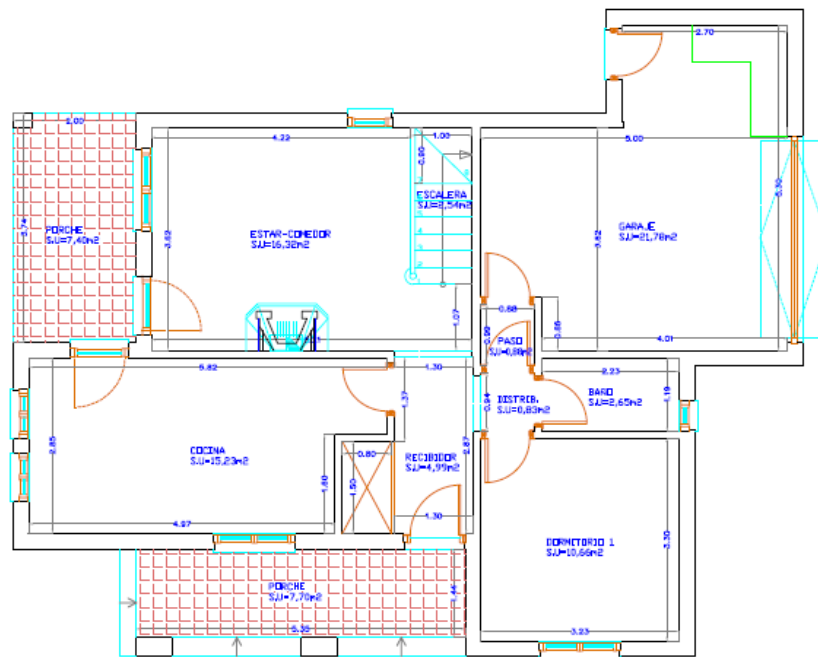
Plano planta baja de la vivienda (Fuente: Elaboración propia)
